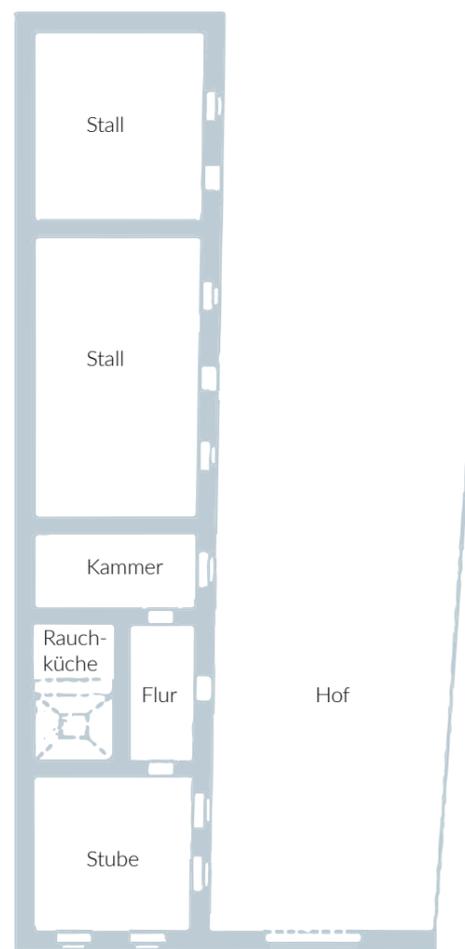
Grundriss Ackerbürgerhaus
